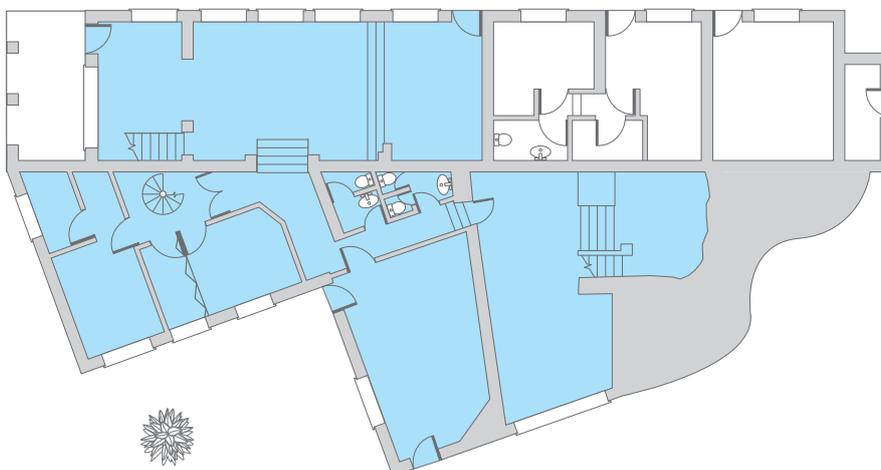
Planta baja del edificio. En azul, zona en la que se interviene
